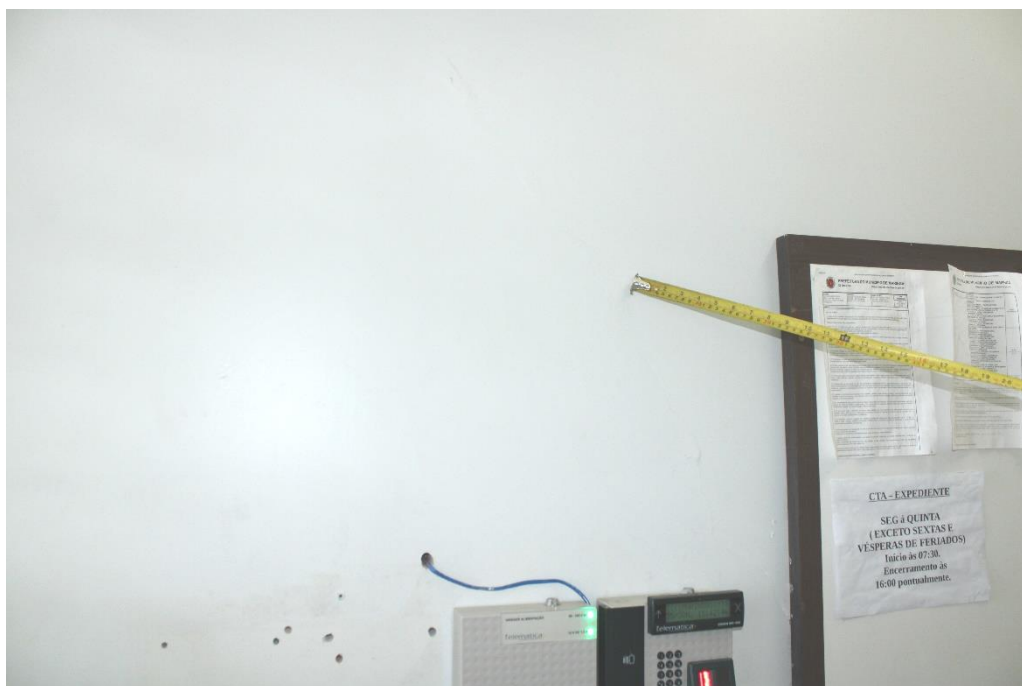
Vista parcial do corredor (parede confinante a sala 53), destacando sinais de correções de fissuras.
